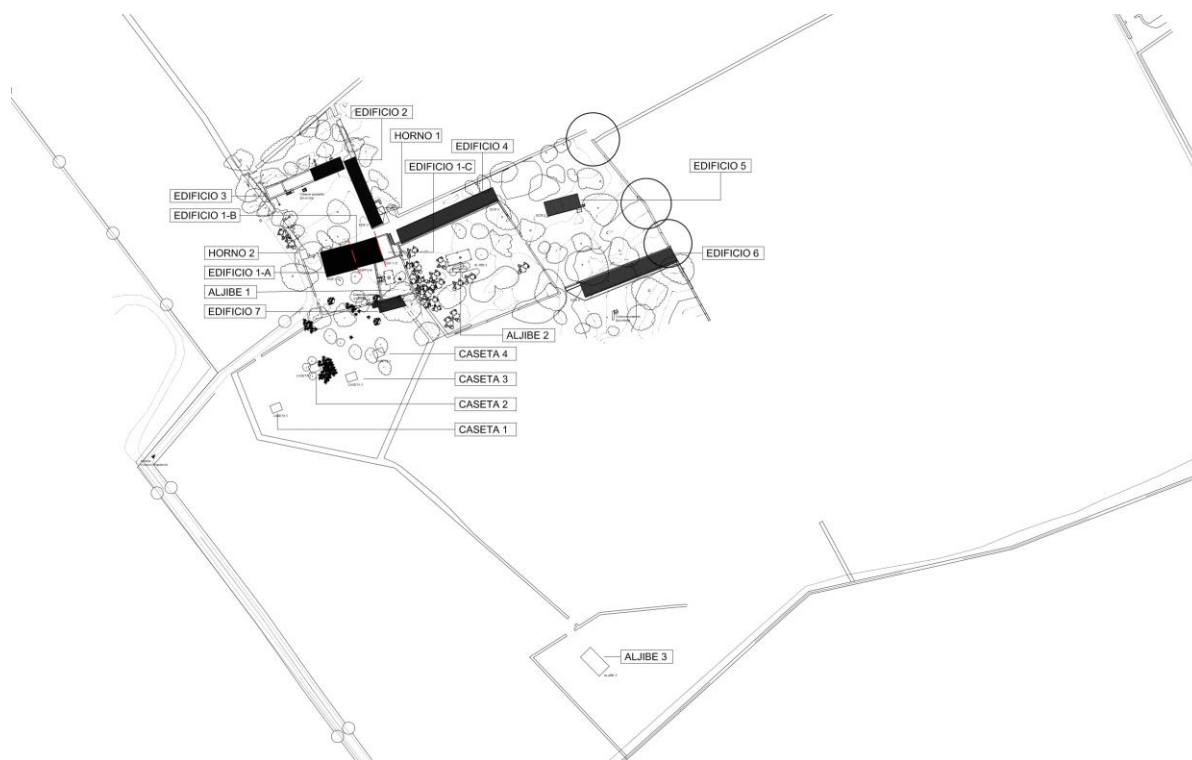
EMPLAZAMIENTO. ESTADO ACTUAL (FUENTE. PROYECTO)
